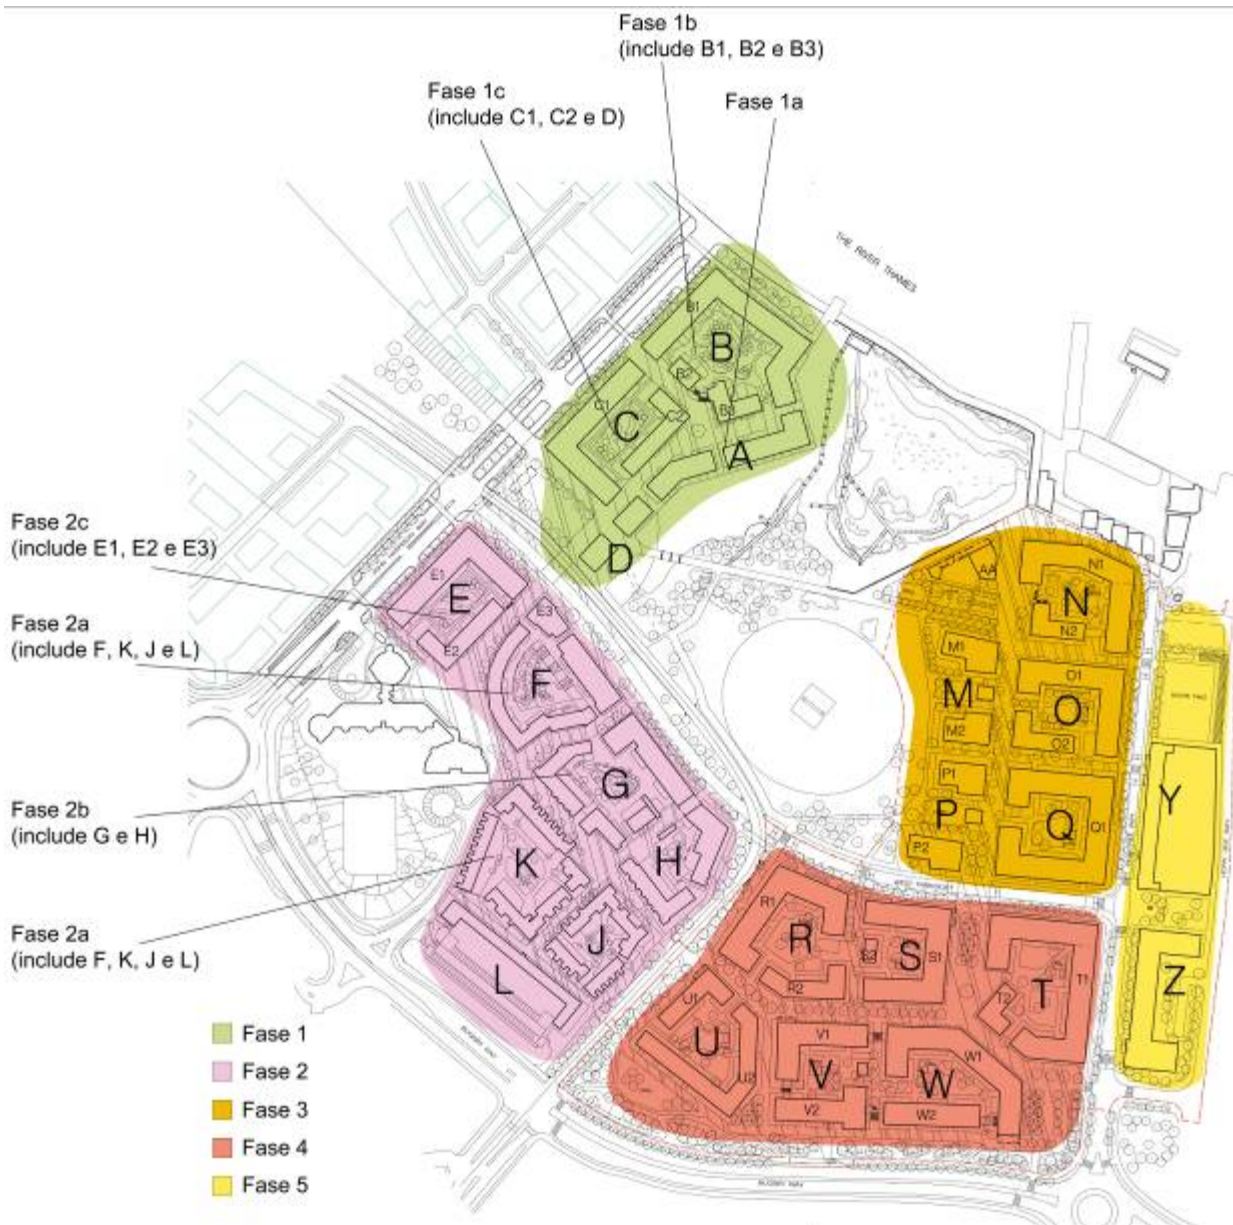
GMV planimetria con illustrazione delle fasi di realizzazione
